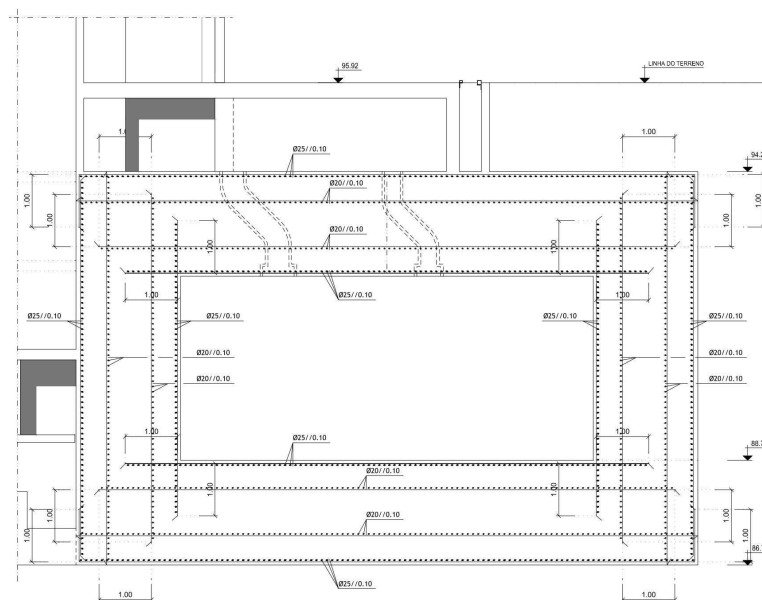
Armadura das paredes e lajes da sala do ciclotrão
